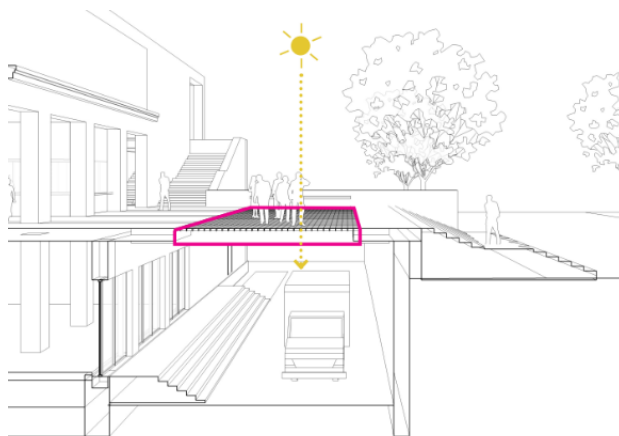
Схема расположения светопрозрачного фрагмента перекрытия [1]
